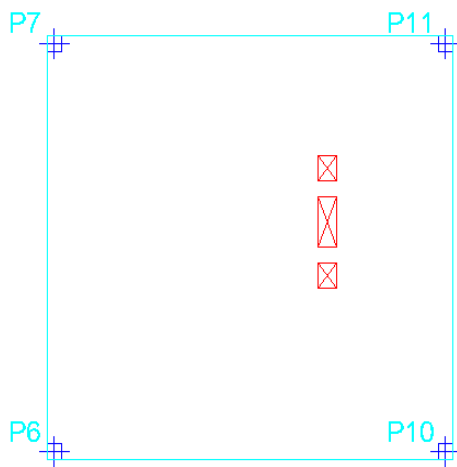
vista en planta del replanteo de planta cubierta
